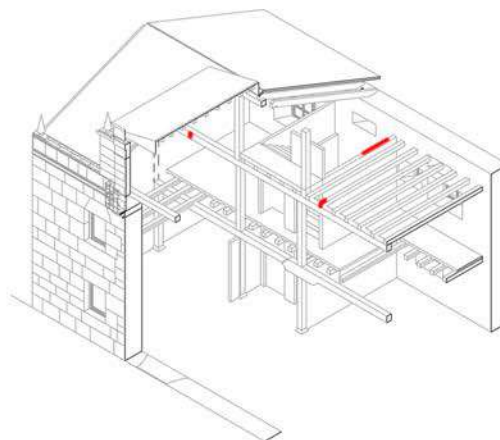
Axonometría que marca donde algunas de las viguetas quemadas. Fuente: Elaborado por el autor
